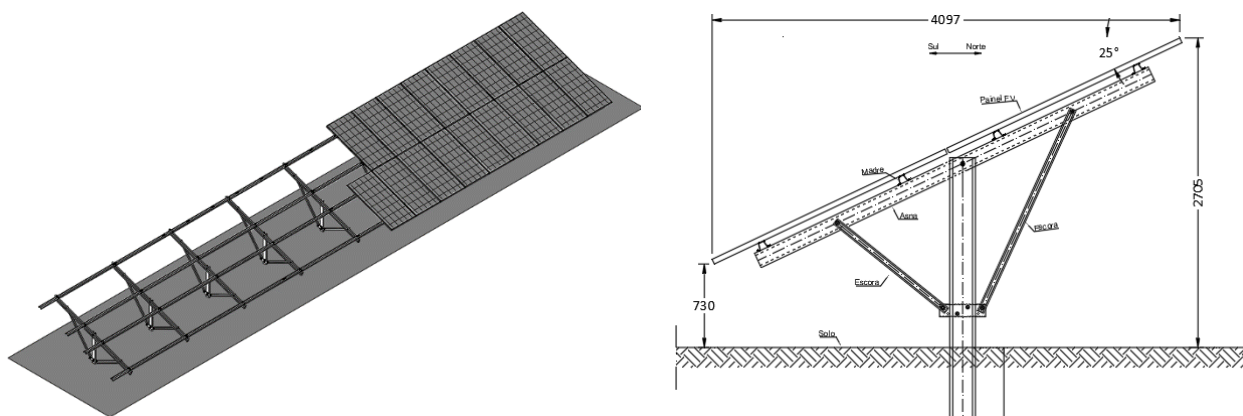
Exemplo da estrutura de suporte dos painéis (Detalhe e vista em corte).
